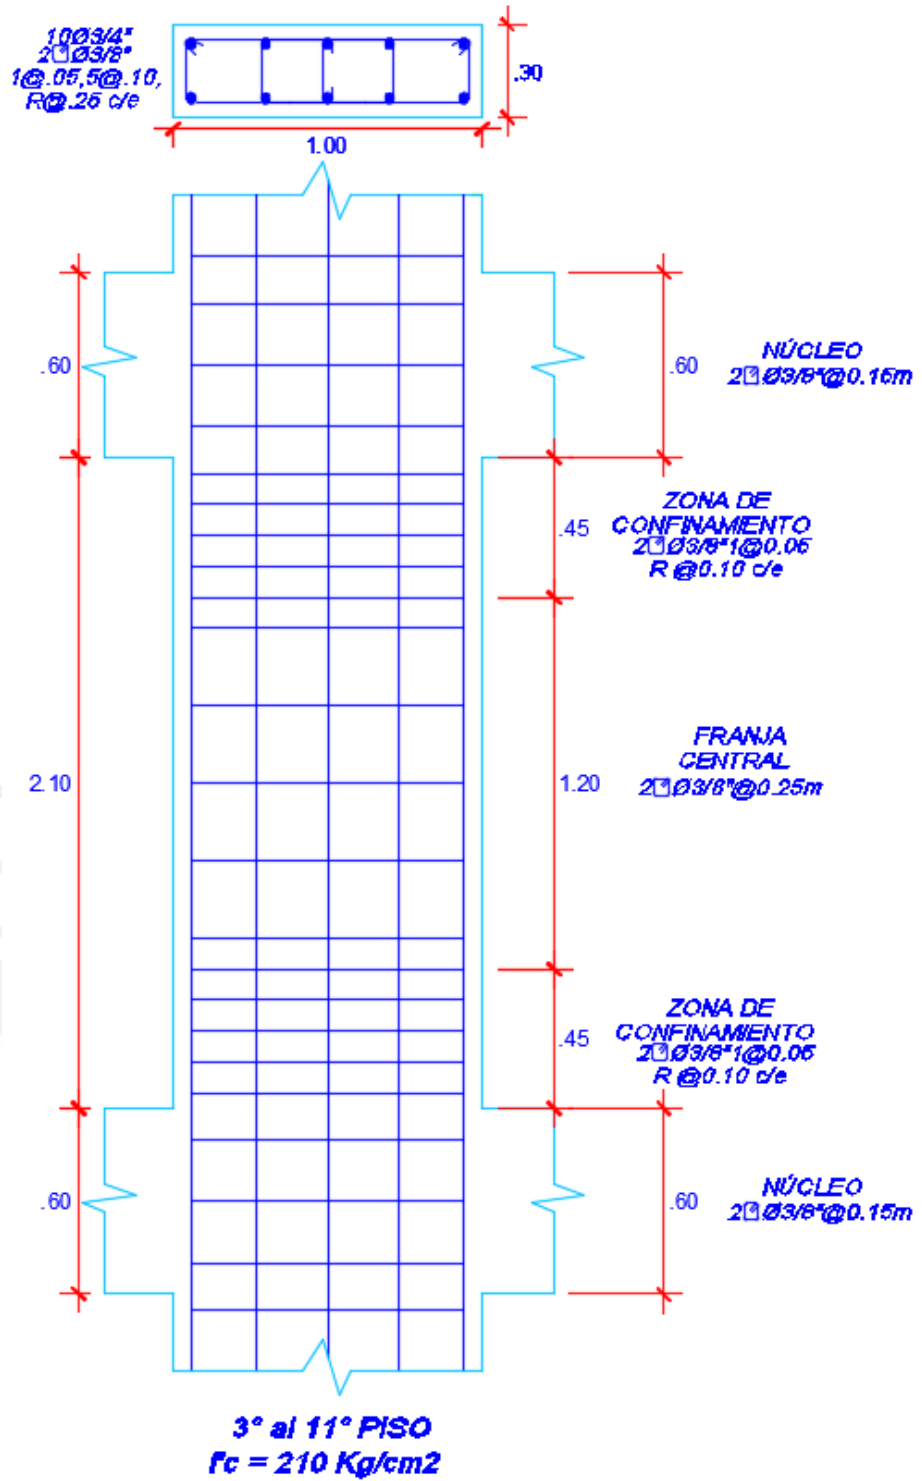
Esquema final de la columna C1 en AutoCAD 2016.
